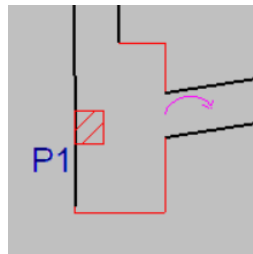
Pilar P1 (Fonte: CYPE)
